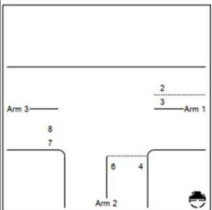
Uitsnede aansluiting planvoornemen op Randweg-West (bron: Tek-en-en Tekenfabriek)
